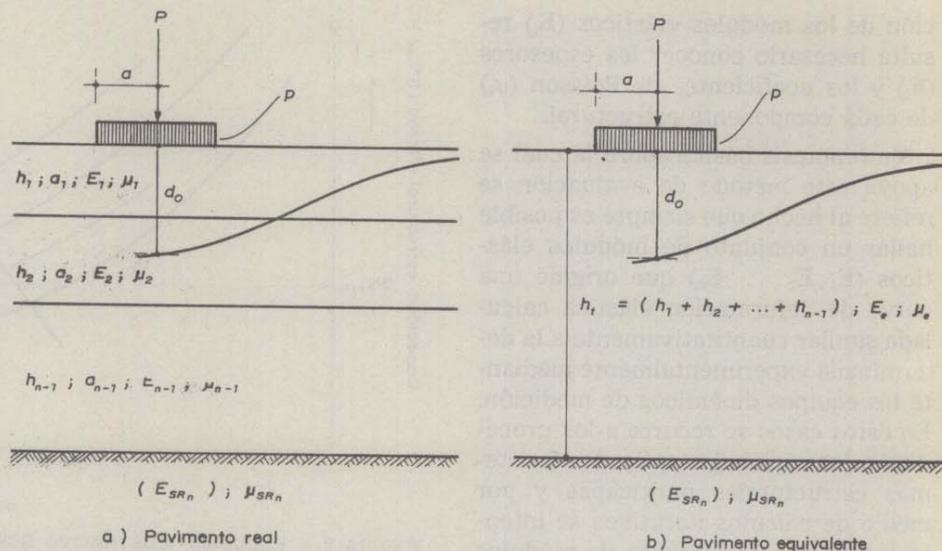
PAVIMENTO REAL Y PAVIMENTO EQUIVALENTE.
